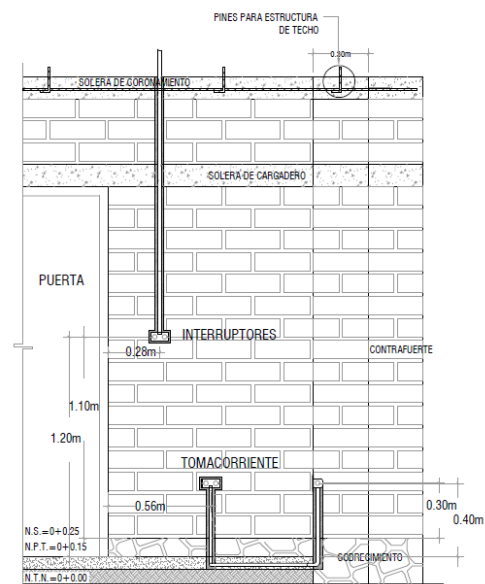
Colocación de sistema eléctrico para la vivienda
